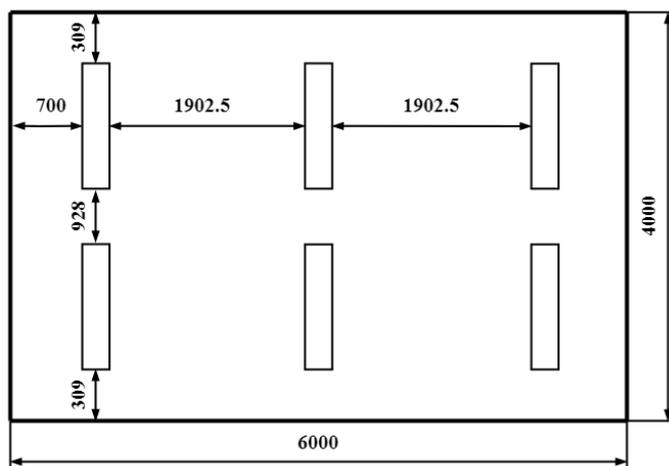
План помещения и размещения светильников с люминесцентными лампами
